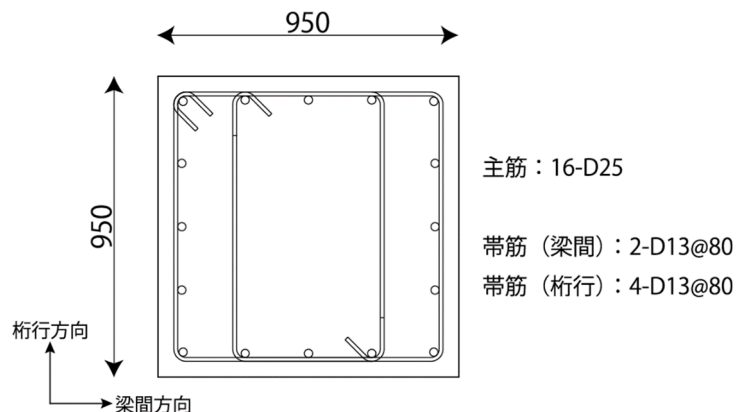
X4Y2 柱断面図（単位：mm）
